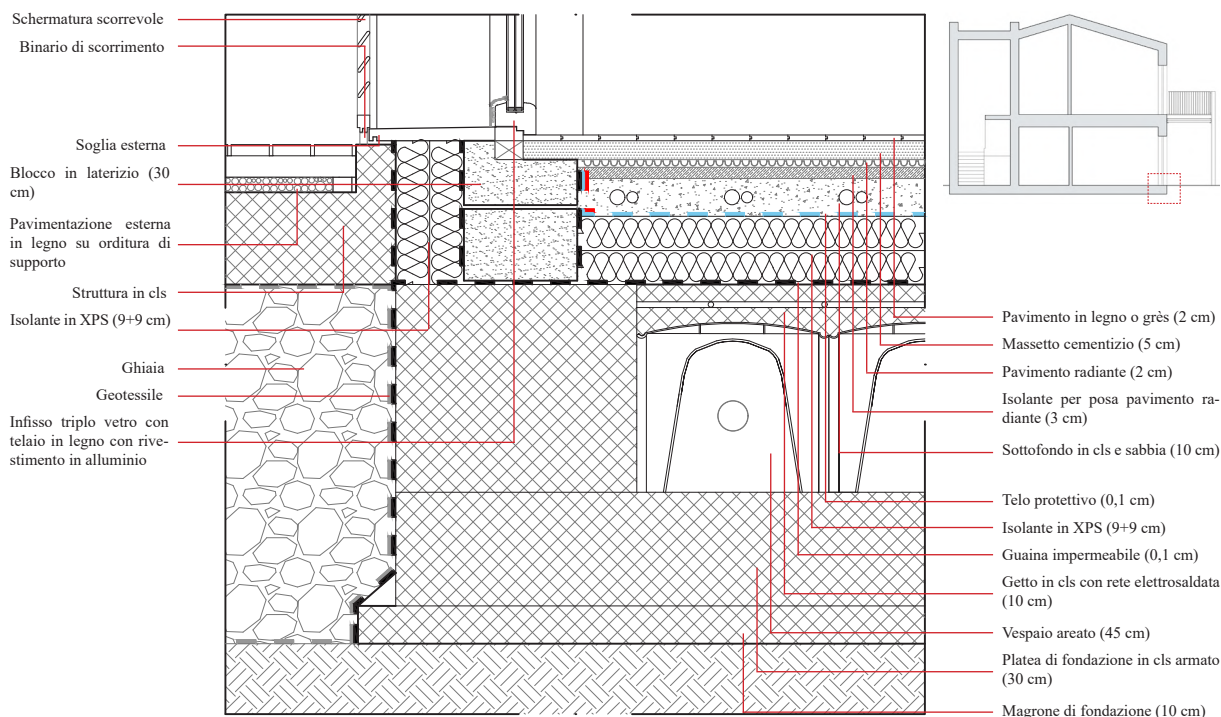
Nodo solaio a terra - parete perimetrale con pavimentazione esterna in legno (scala 1:20)
